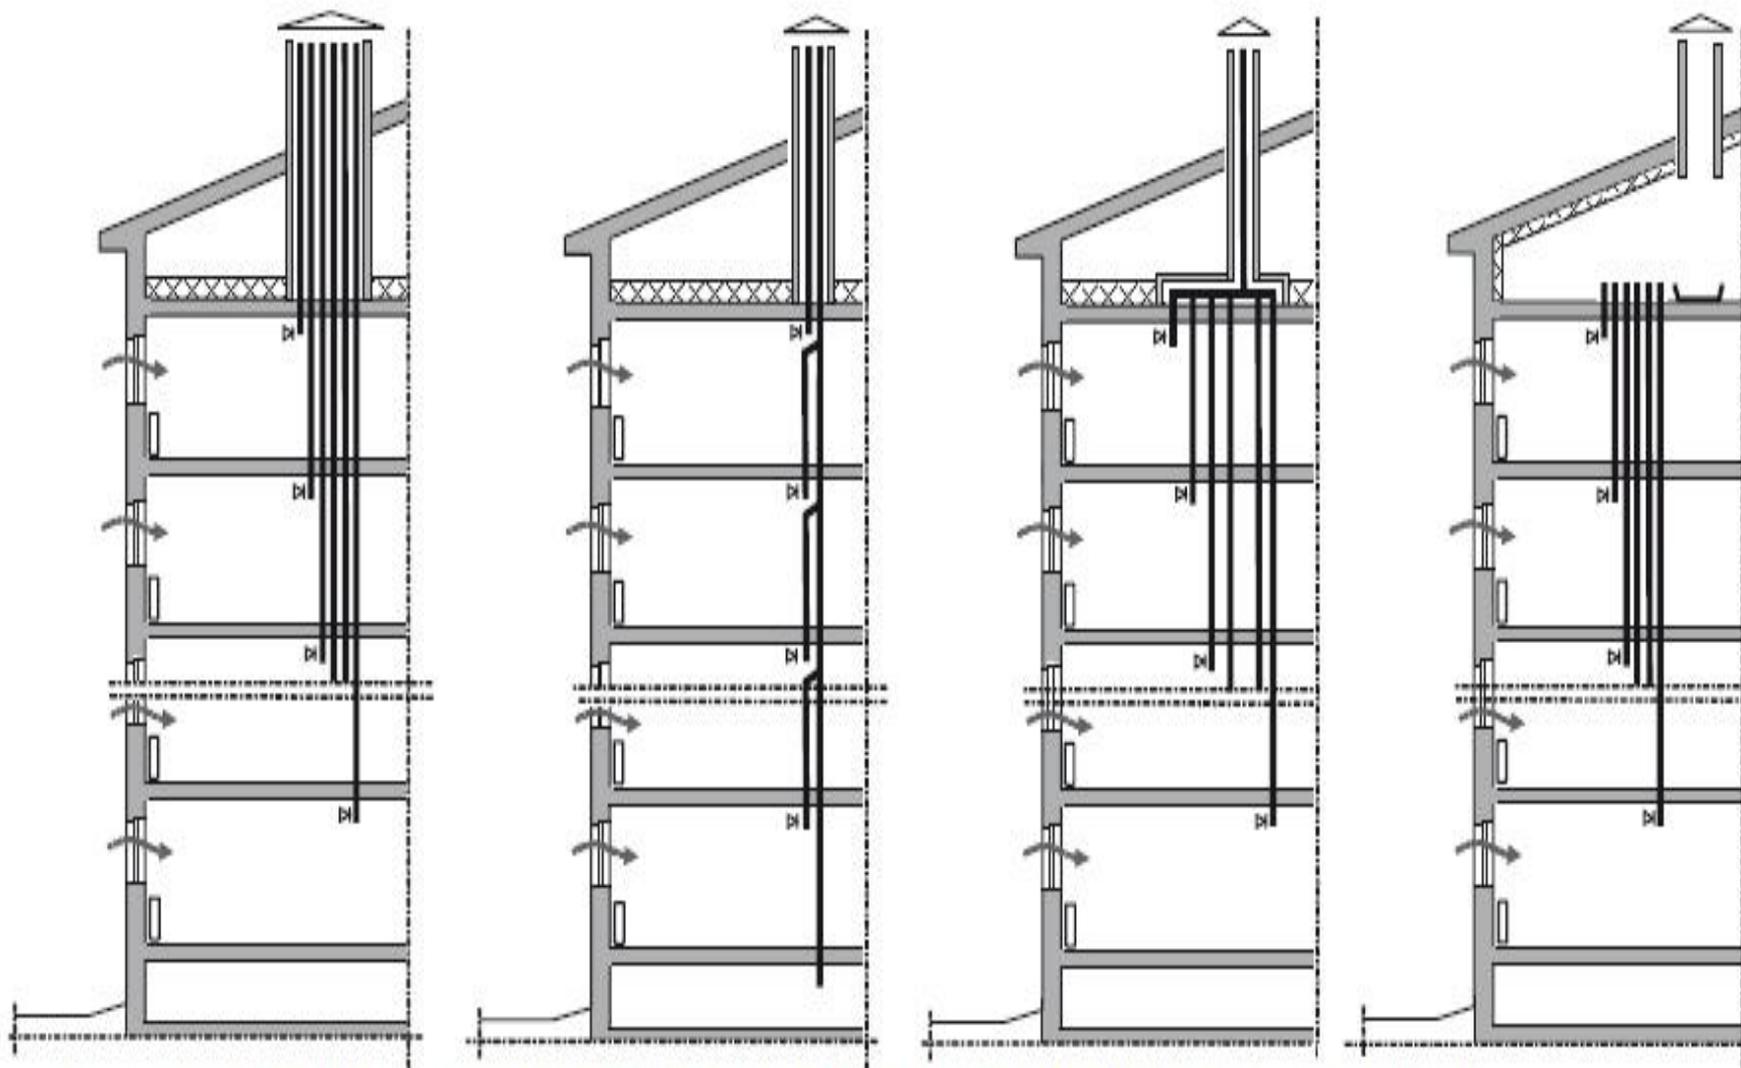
Принципиальные схемы некоторых систем естественной вентиляции жилых зданий :
